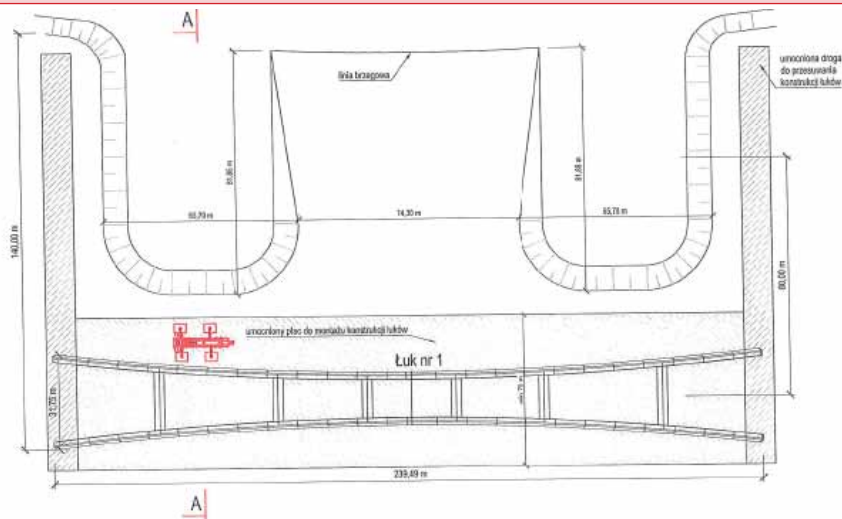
Plac montażowy na którym wykonuje się scalanie elementów stalowych łuków
